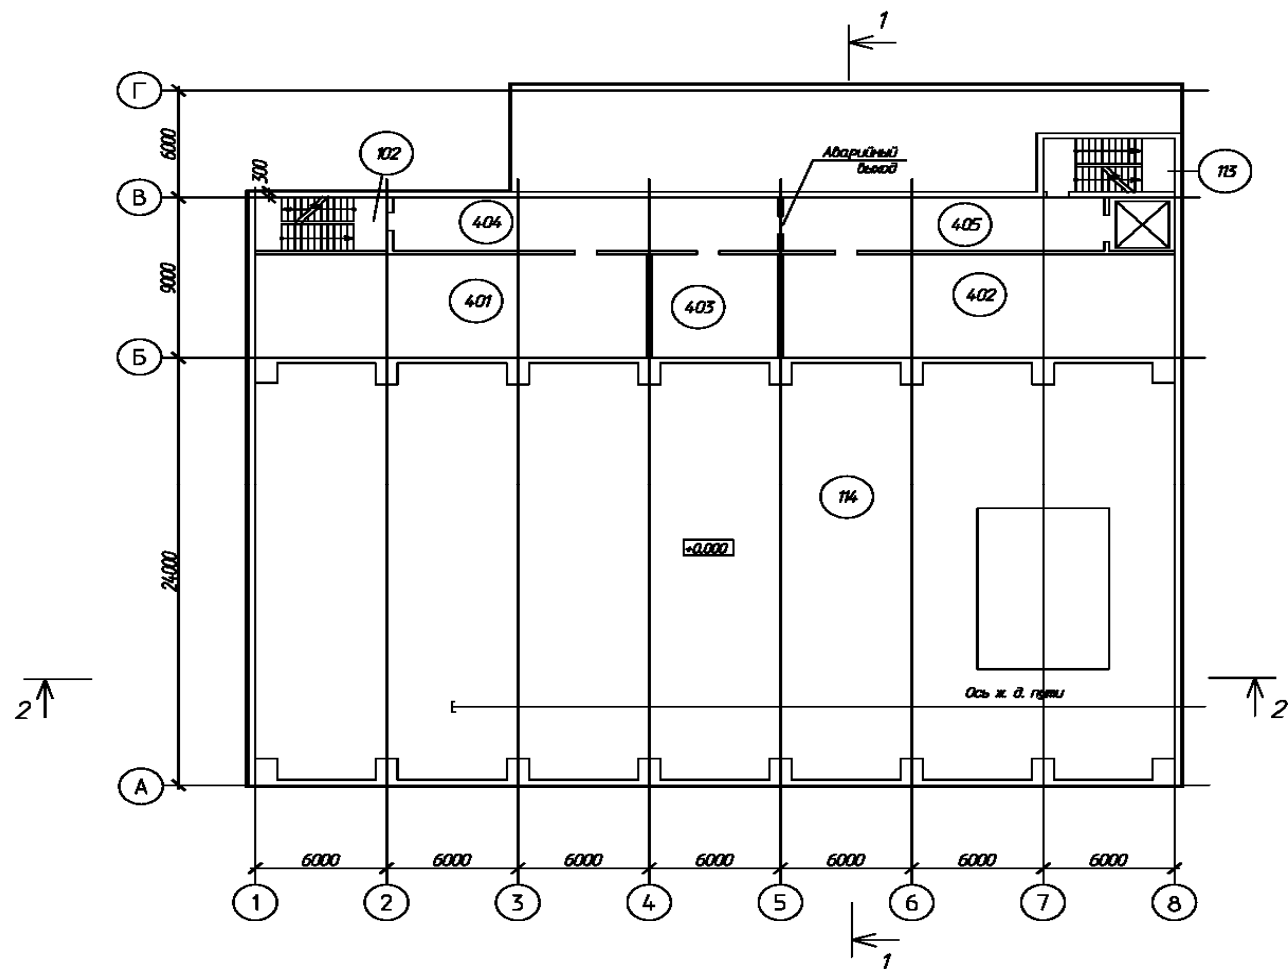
Здание приемки. План на отметке 11,100
